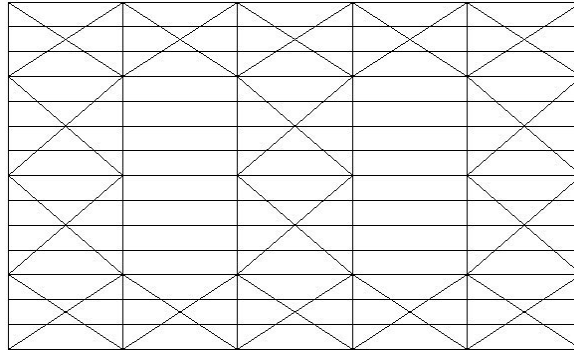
| Distribucion de arriostramientos en cubierta.-
